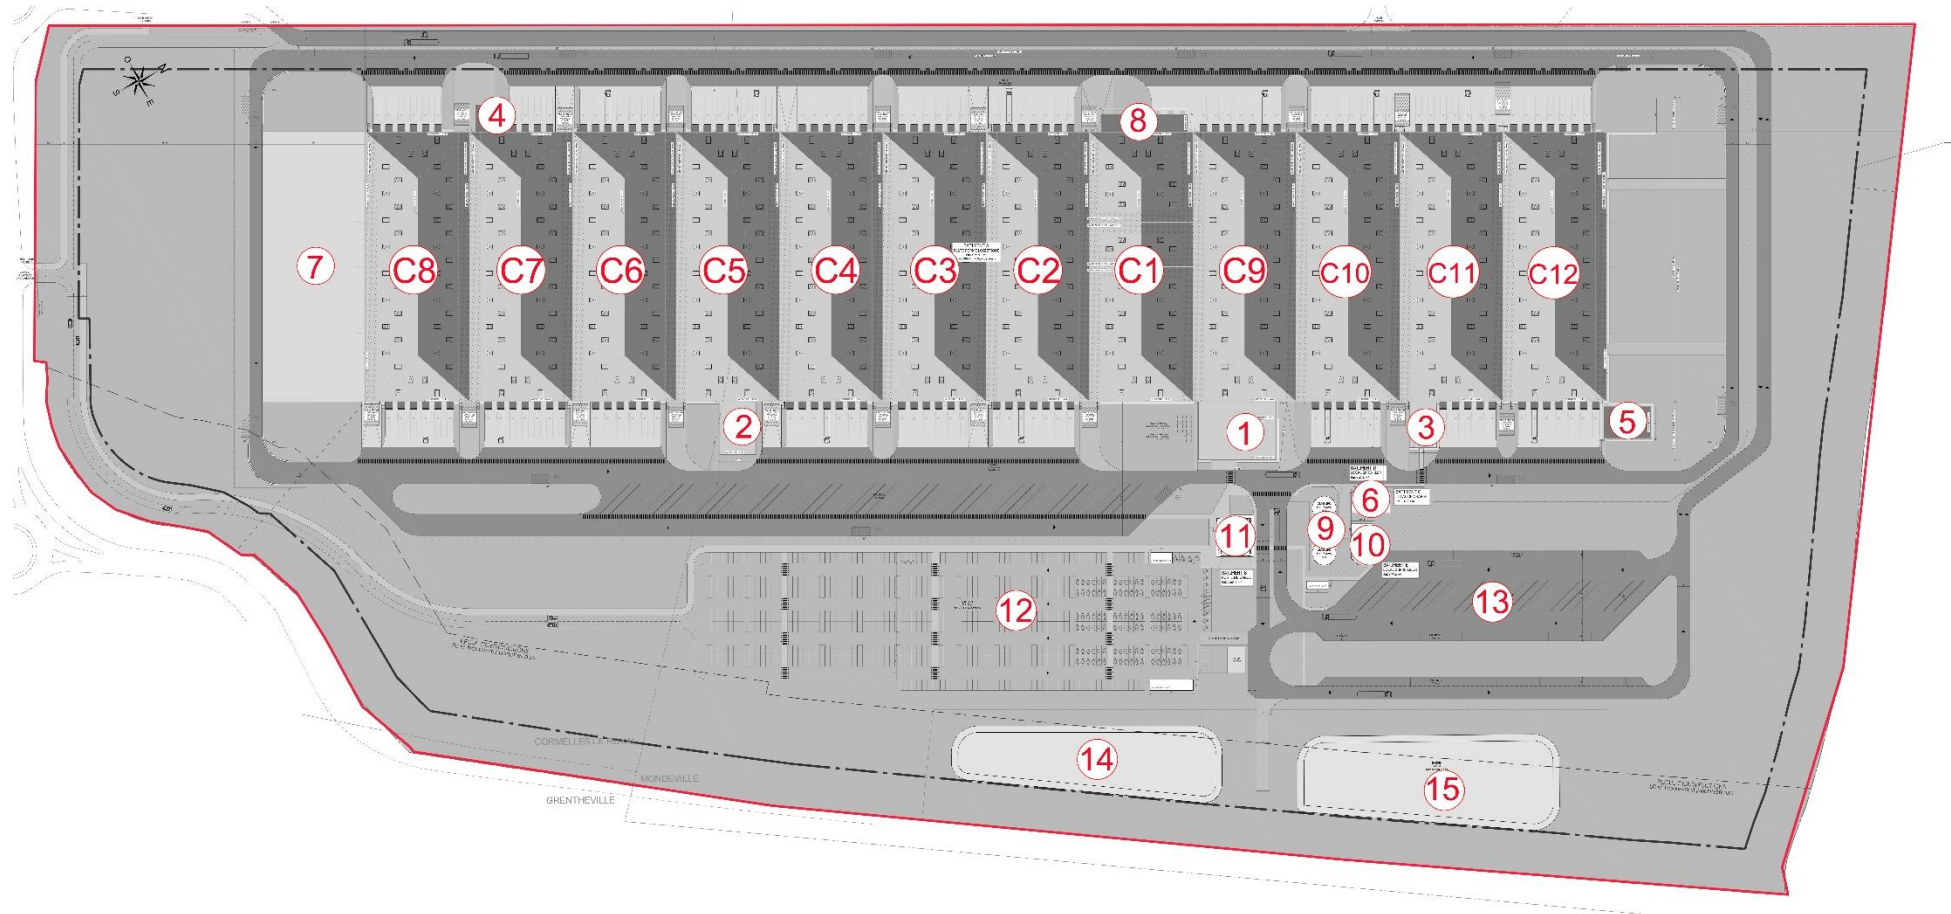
Agencement des installations du site CARGO PROPERTY DEVELOPMENT (extrait plan masse)
